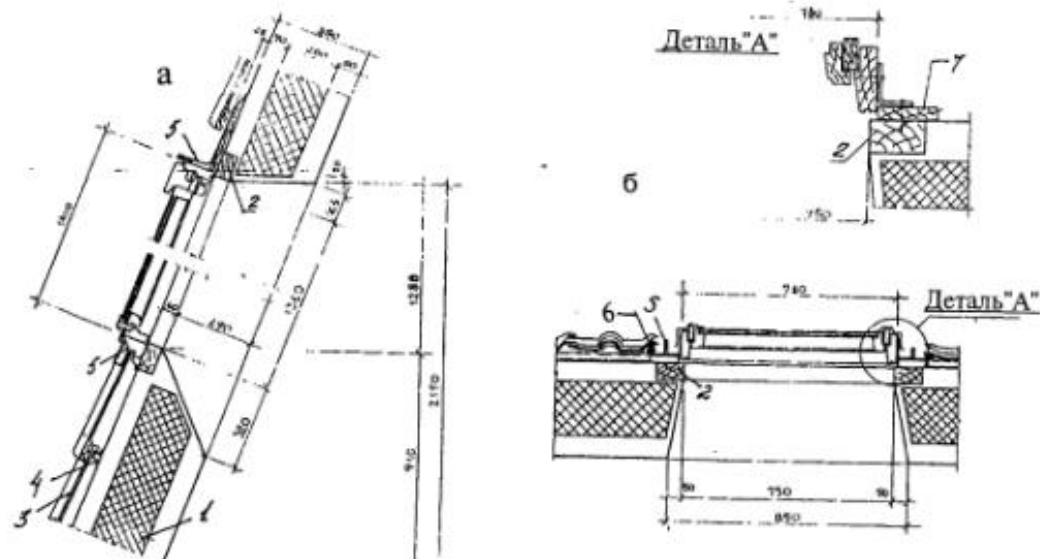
Установка окна системы "Бравс-ДСК-1" в наклонную железобетонную панель наружной стены мансарды: а - продольный; б - поперечный разрез; 1 - панель стены; 2 - закладной деревянный брусок в панели; цементно-песчаная черепица; 4 - металлическая оцинкованная обрешетка; 5 - стальной оцинкованный "воротник" по контуру окна; 6 - герметик по уплотняющей прокладке; 7 - доска
